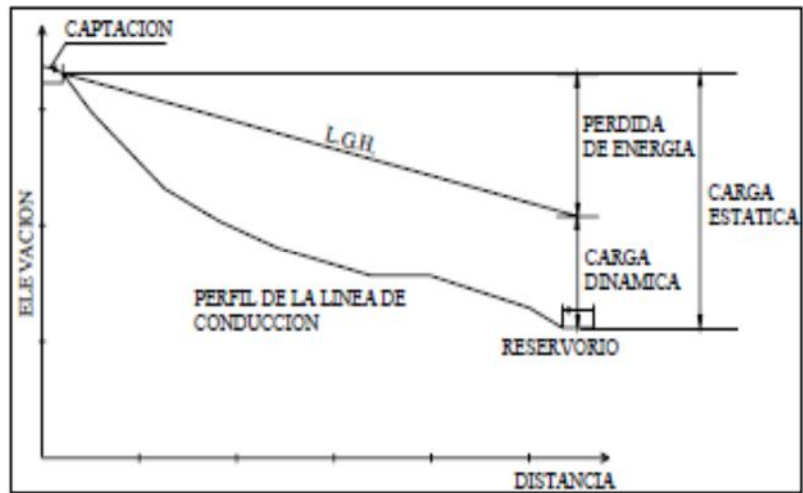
Cálculo de la Carga Dinámica y Estática de Tubería
